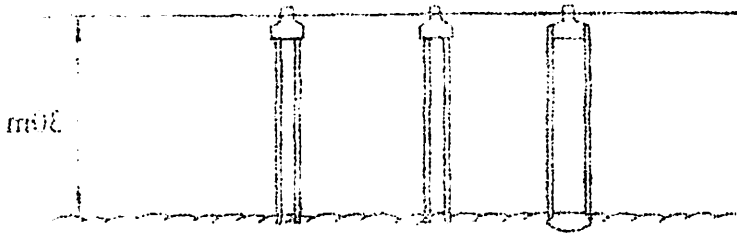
Contoh pondasi bila lapisan pendukung pondasi berada sekitar 10m di bawah permukaan tanah.
